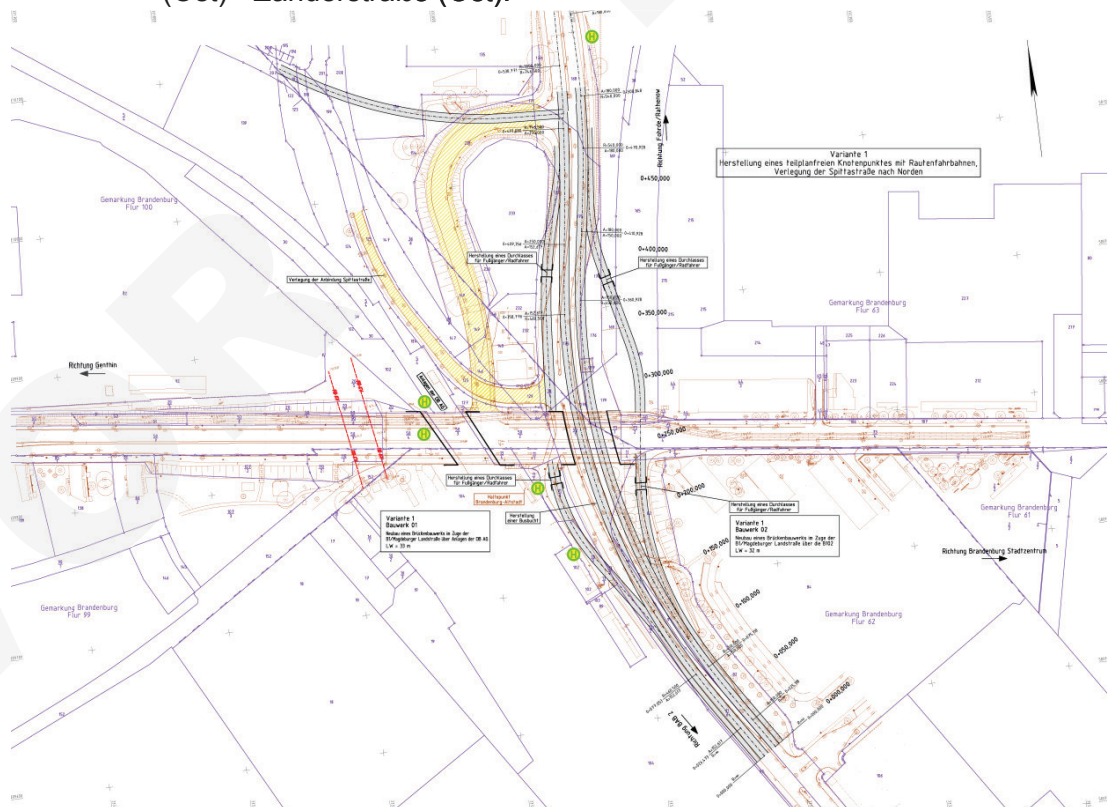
Lageplan, Knotenpunkt B1 / B102, Variante 1¹
